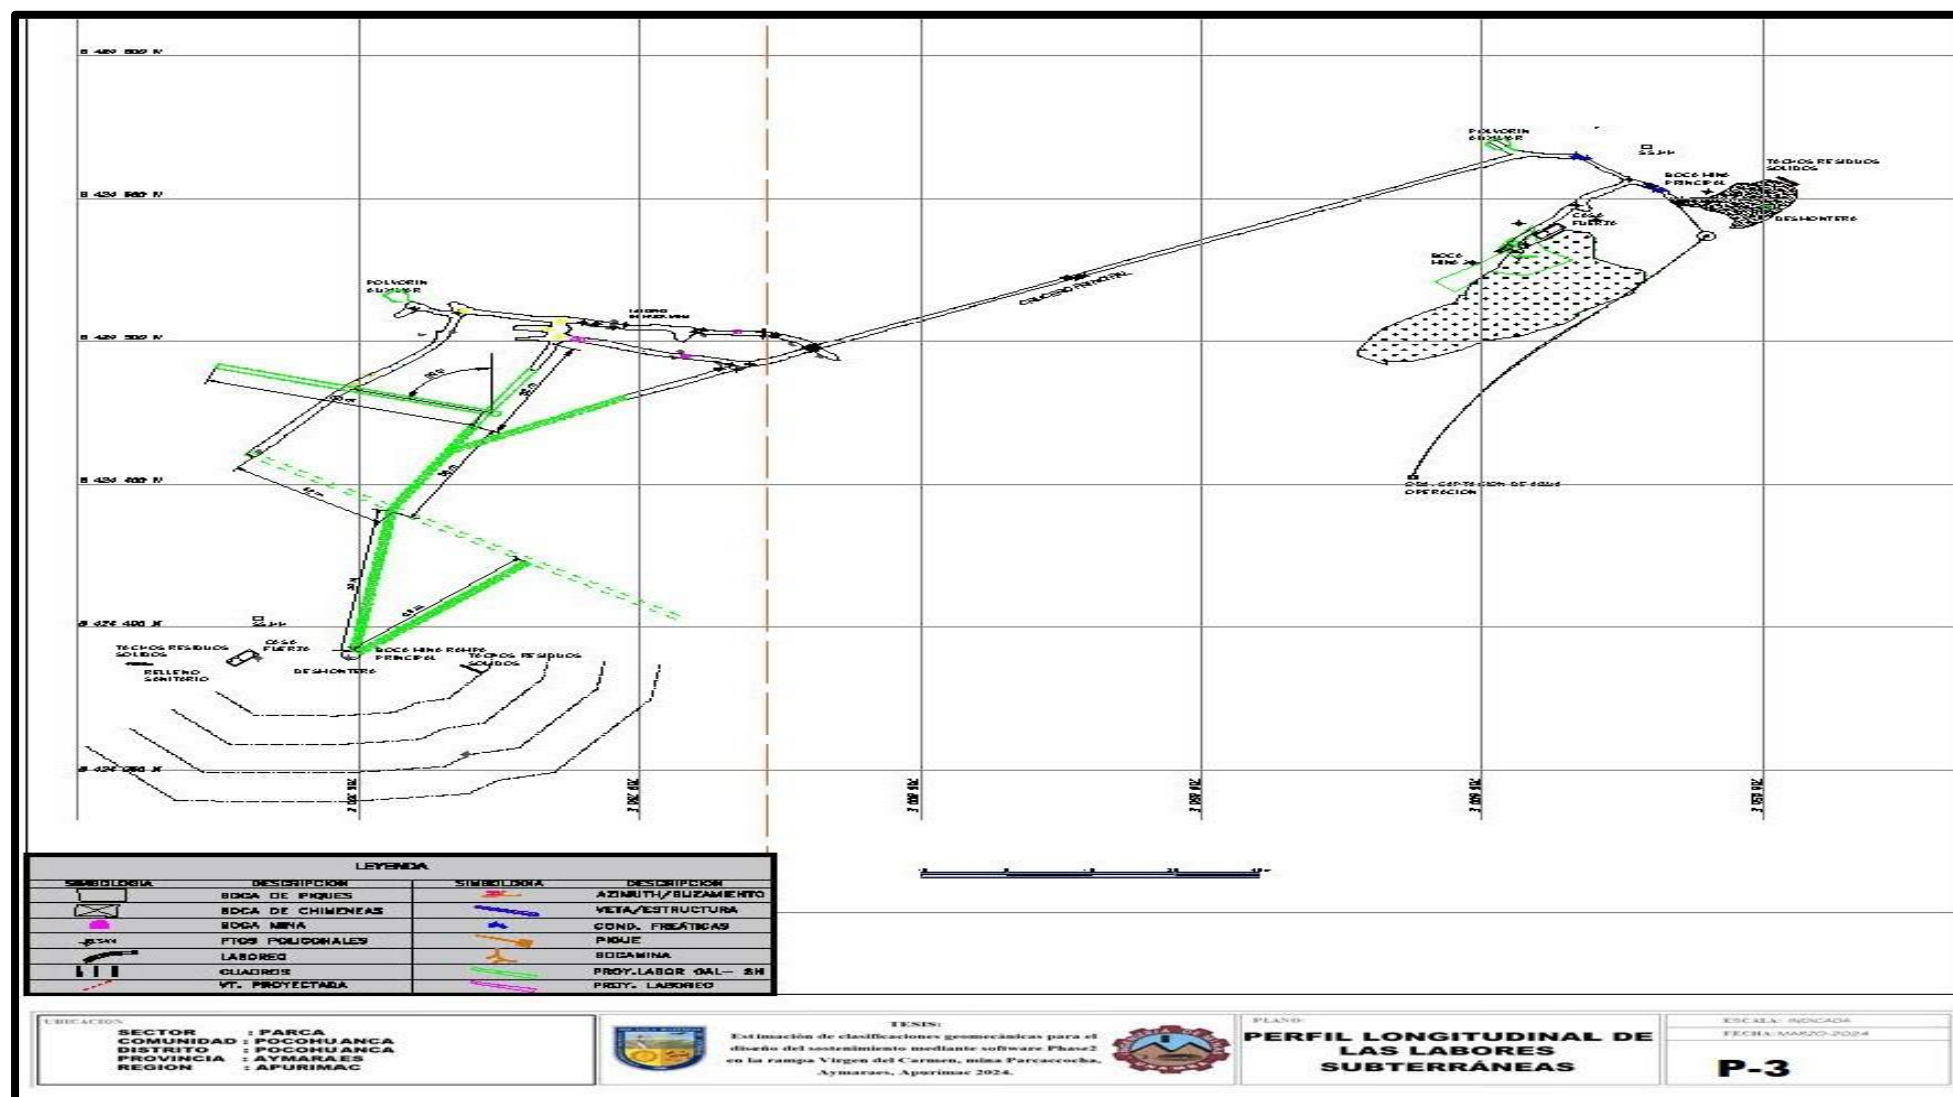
Vista en planta de la rampa Carmen - Pocohuanca
